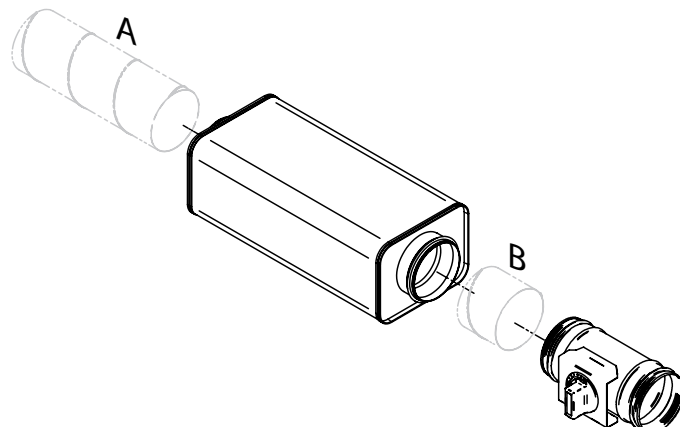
Kit d'air introduit, PARAGON T-SAK-CAV-125
